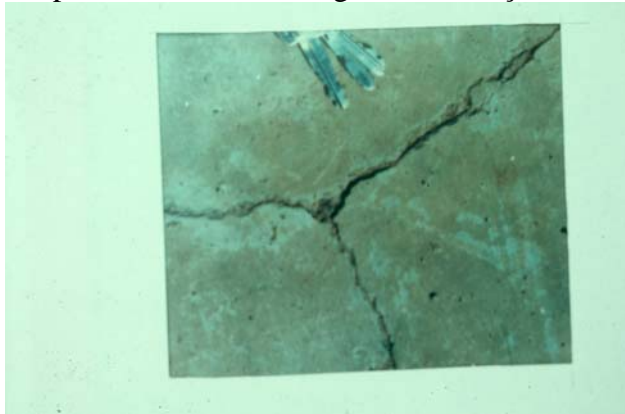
Fissura térmica ocorrida em laje de vertedouro, devido ao elevado teor de aglomerante e “Restrição Plena”
